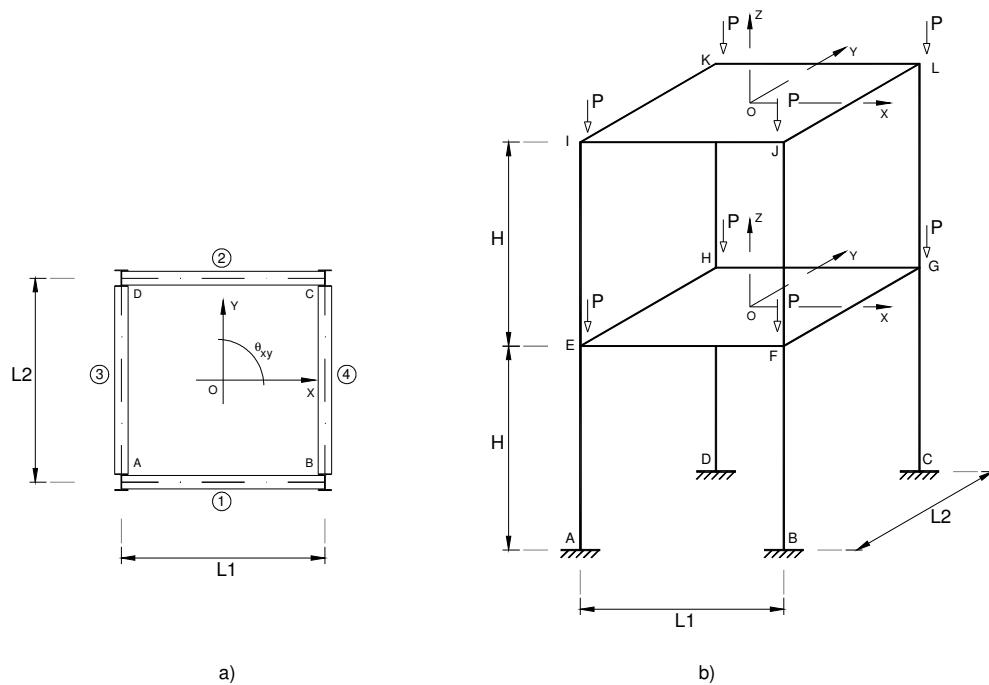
Modelação INST3D – Pórtico 3D: a) planta, b) alçado.
